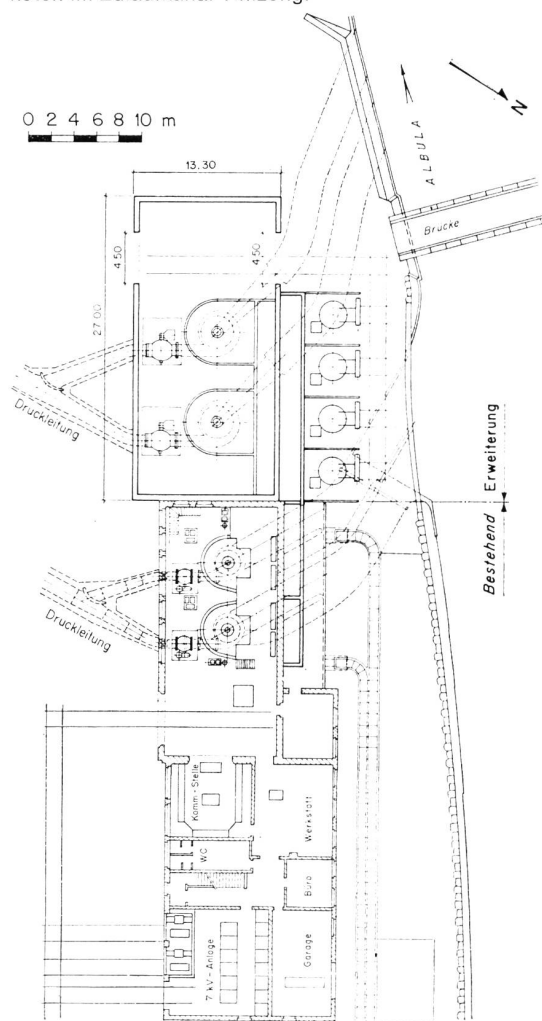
Grundriss der Zentrale Tiefencastel
